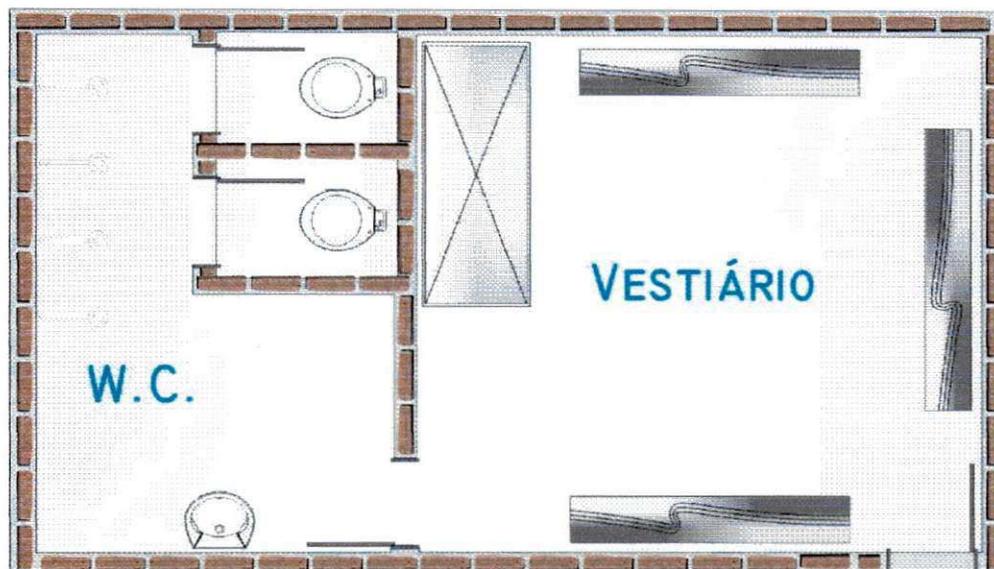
Layout do Vestiário e instalações sanitárias.
